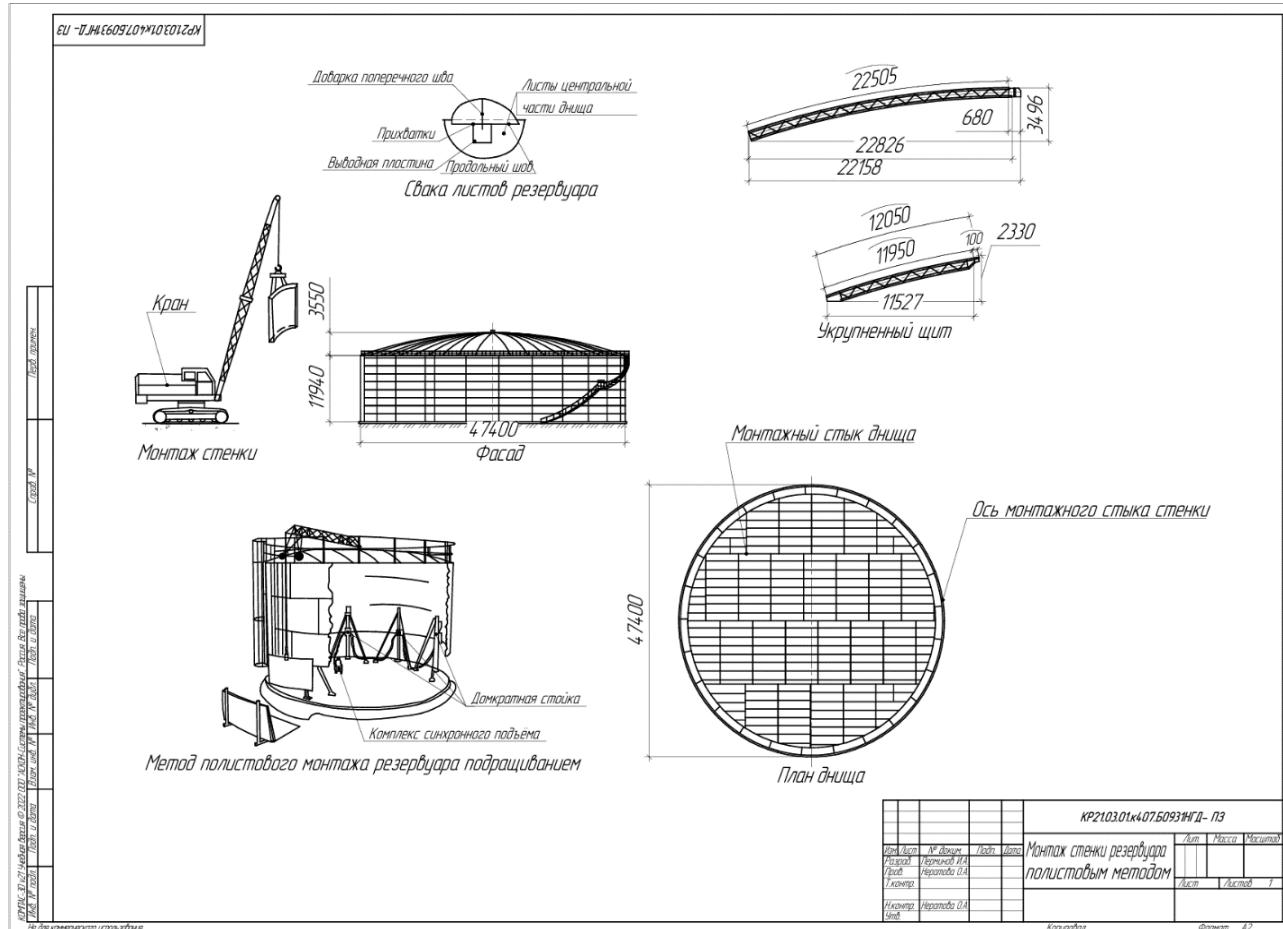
Схема монтажа стенки РВС полистовым методом
